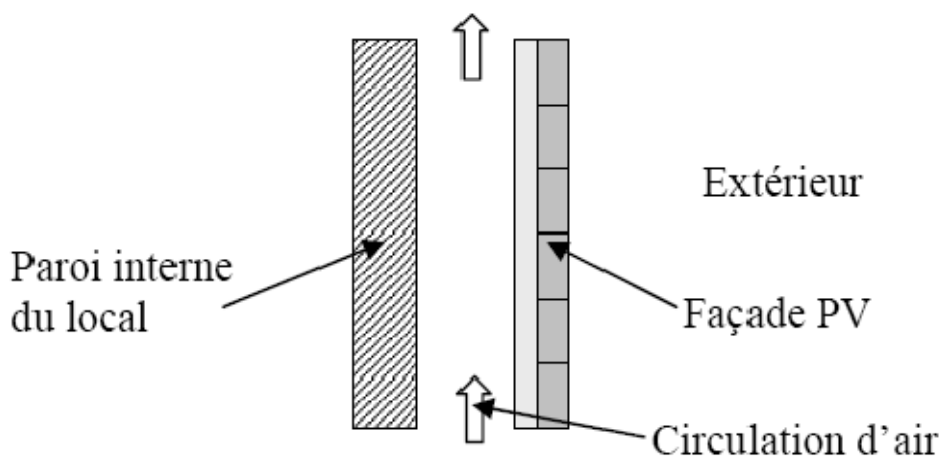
Coupe de la lame d'air en sous-face des panneaux PV [29]
